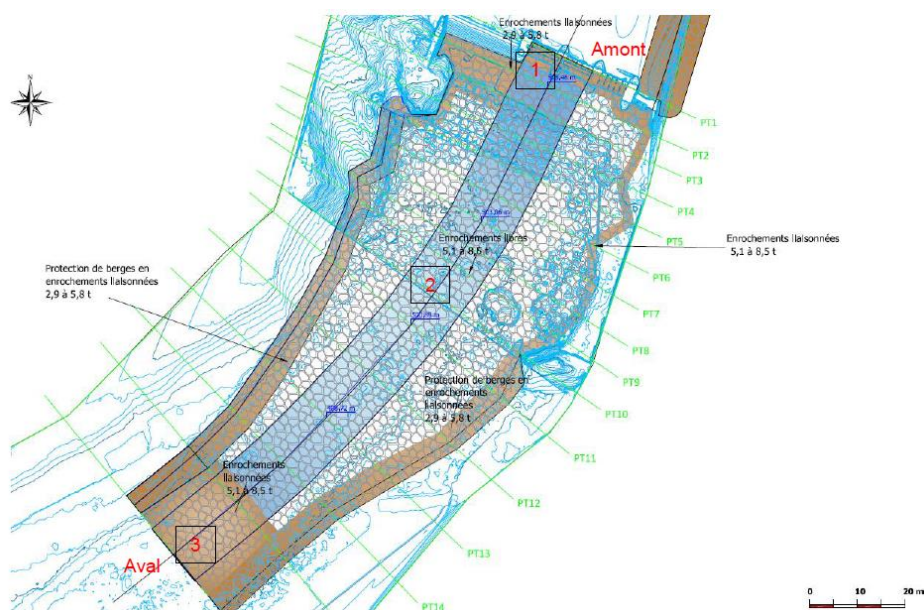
Vue en plan de la rampe piscicole (Burgeap)
